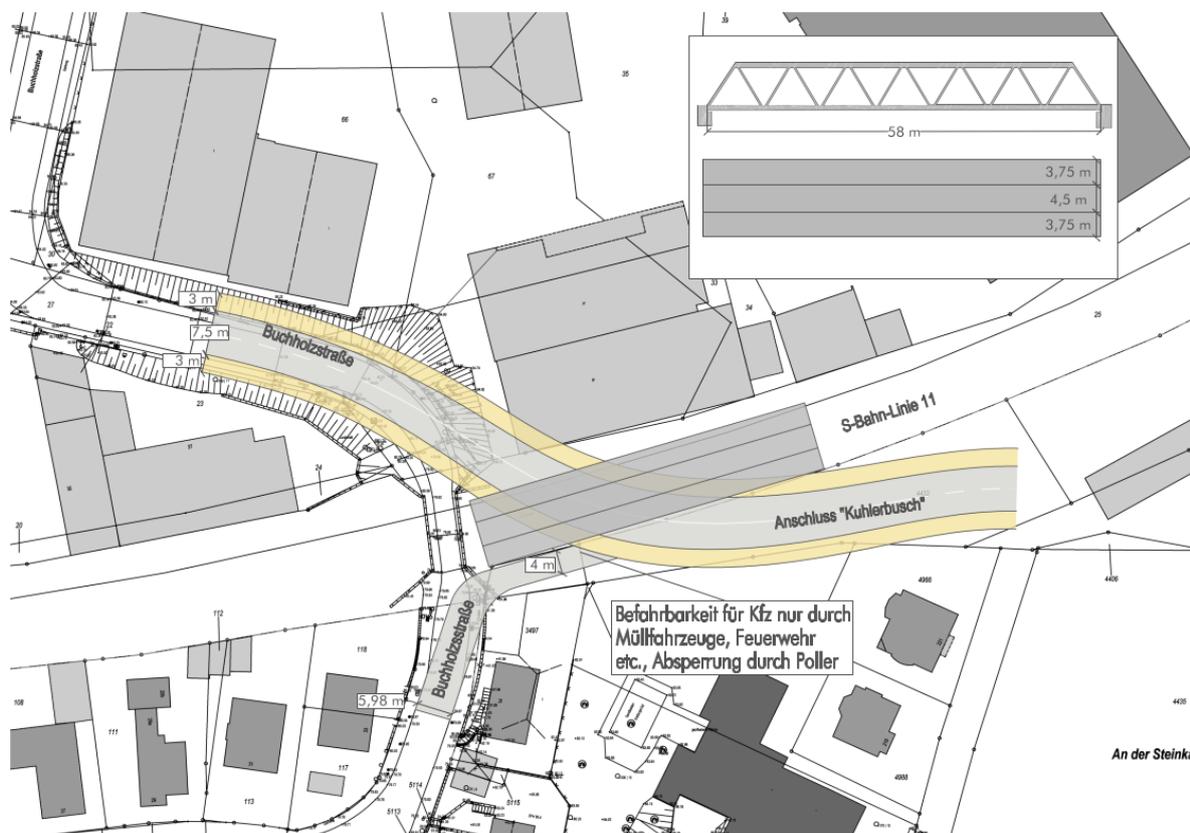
Entwurf Straßenführung und Brückenbauwerk Buchholzstraße
